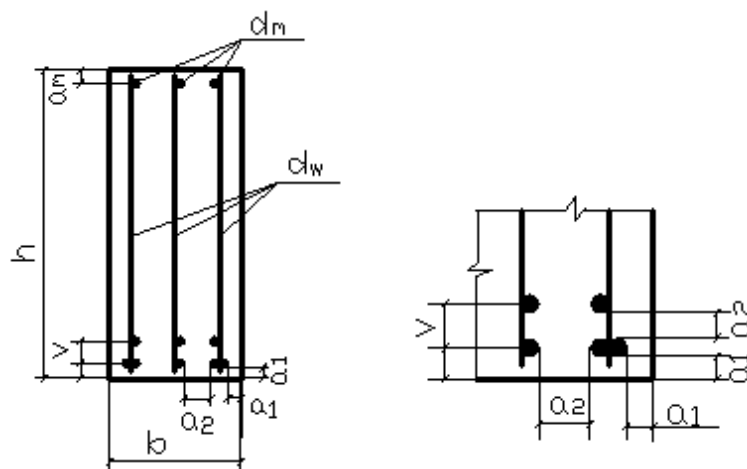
Размещение рабочей продольной арматуры ригеля
